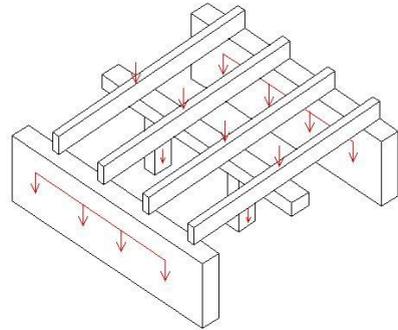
Esquema estructural planta segunda y desván. 2014. Propia.
